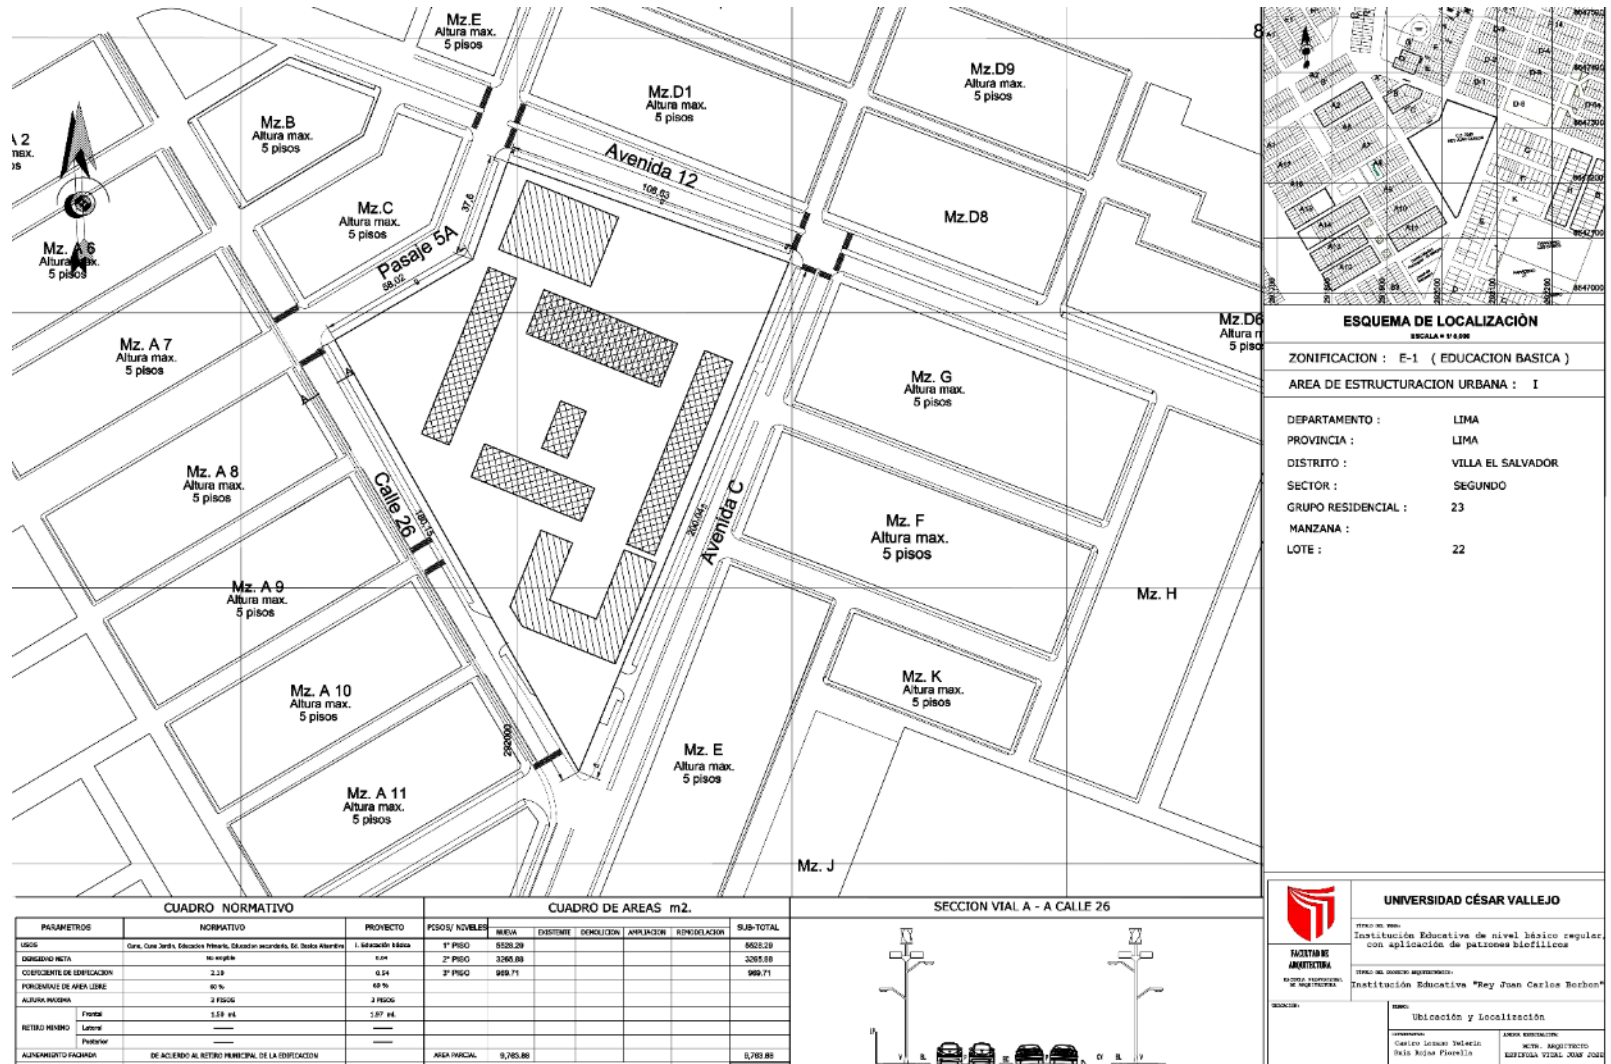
Plano de ubicación, Fuente: elaboración propia
